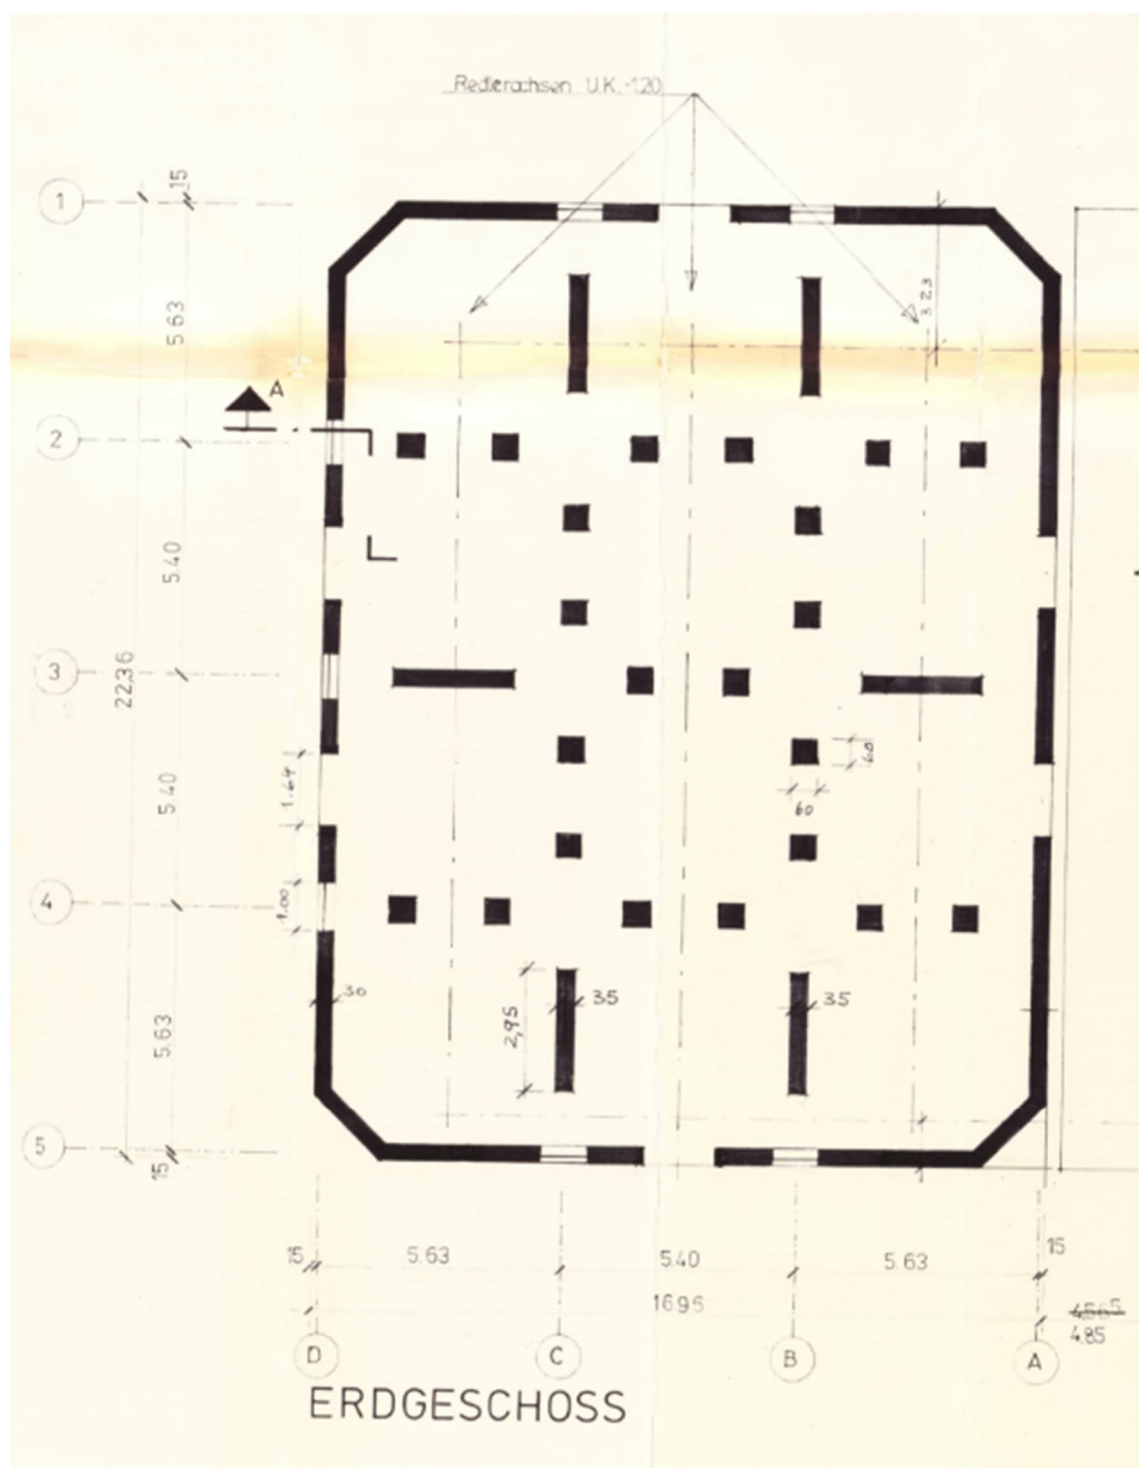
Bestandsgrundriss EG Silogeäude D4
